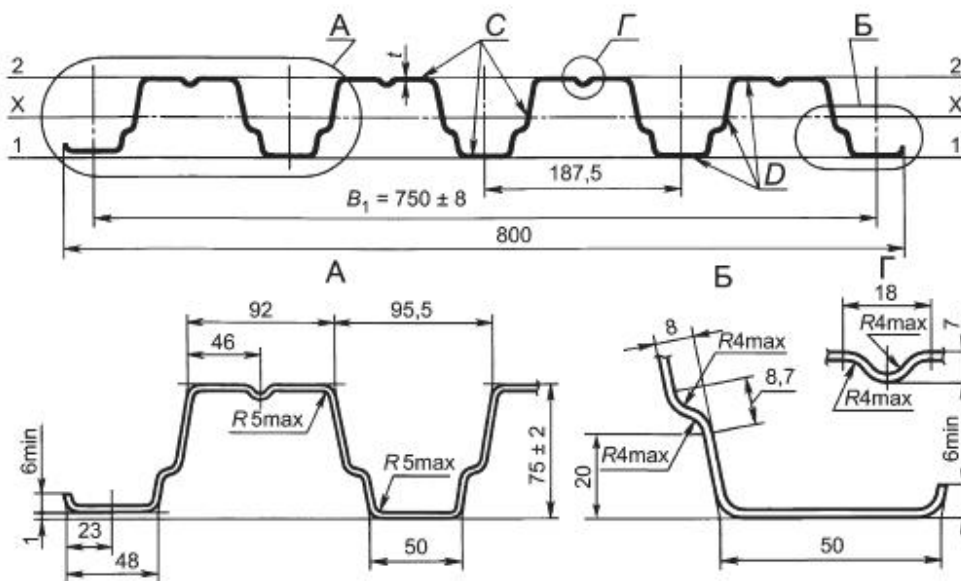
К расчету сталежелезобетонного перекрытия
